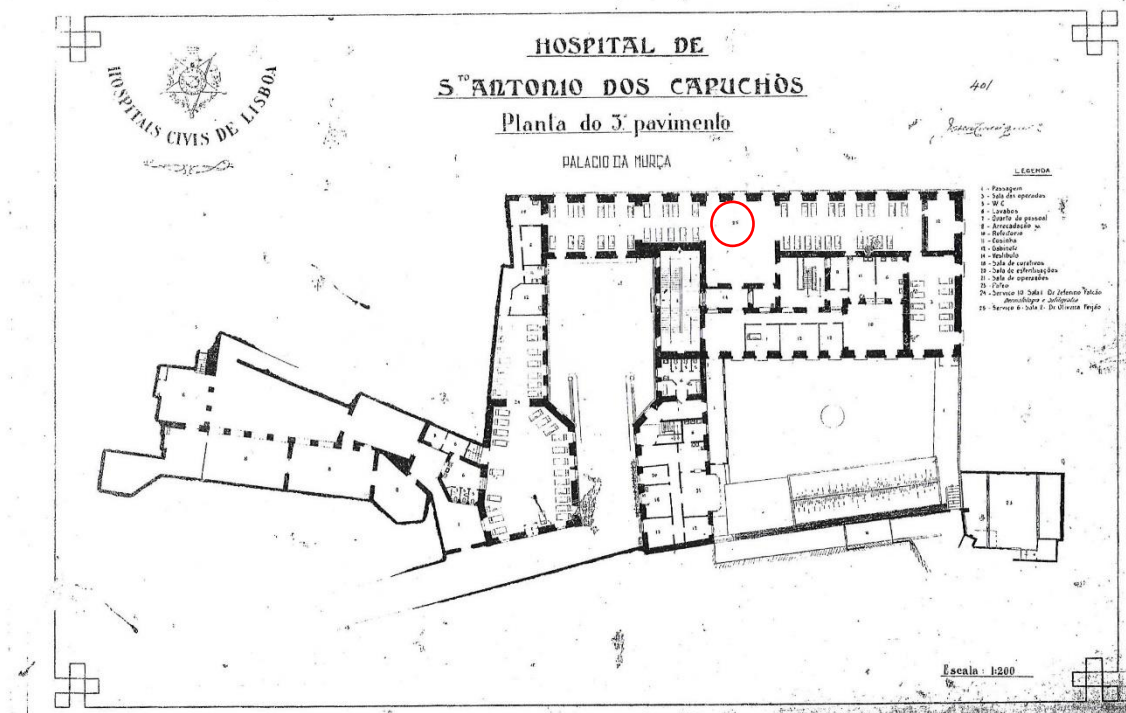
Planta do Antigo Palácio Murça, 3º Pavimento – Enfermaria das mulheres (DGPC/SIPA, Cota: DES 00028070).
